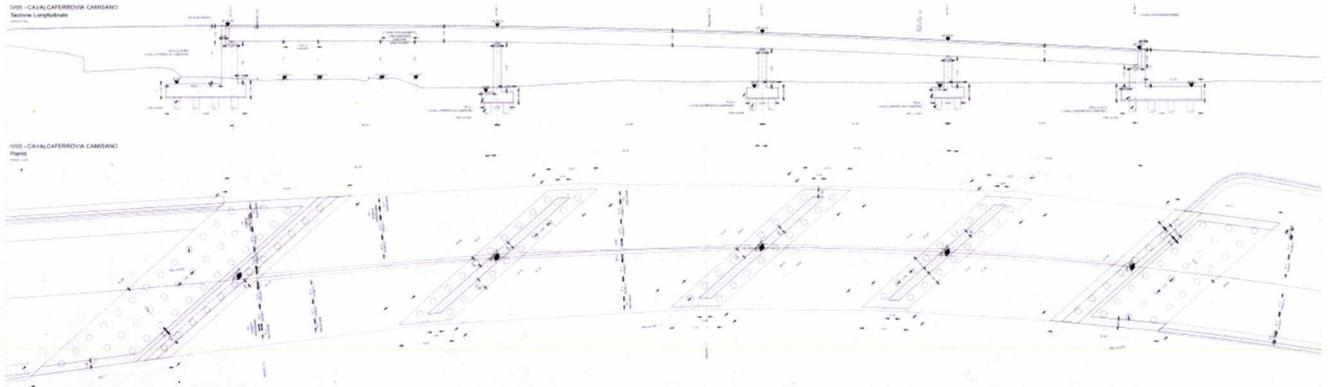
Planimetria e Profilo del Cavalcaferrovia Camisano
